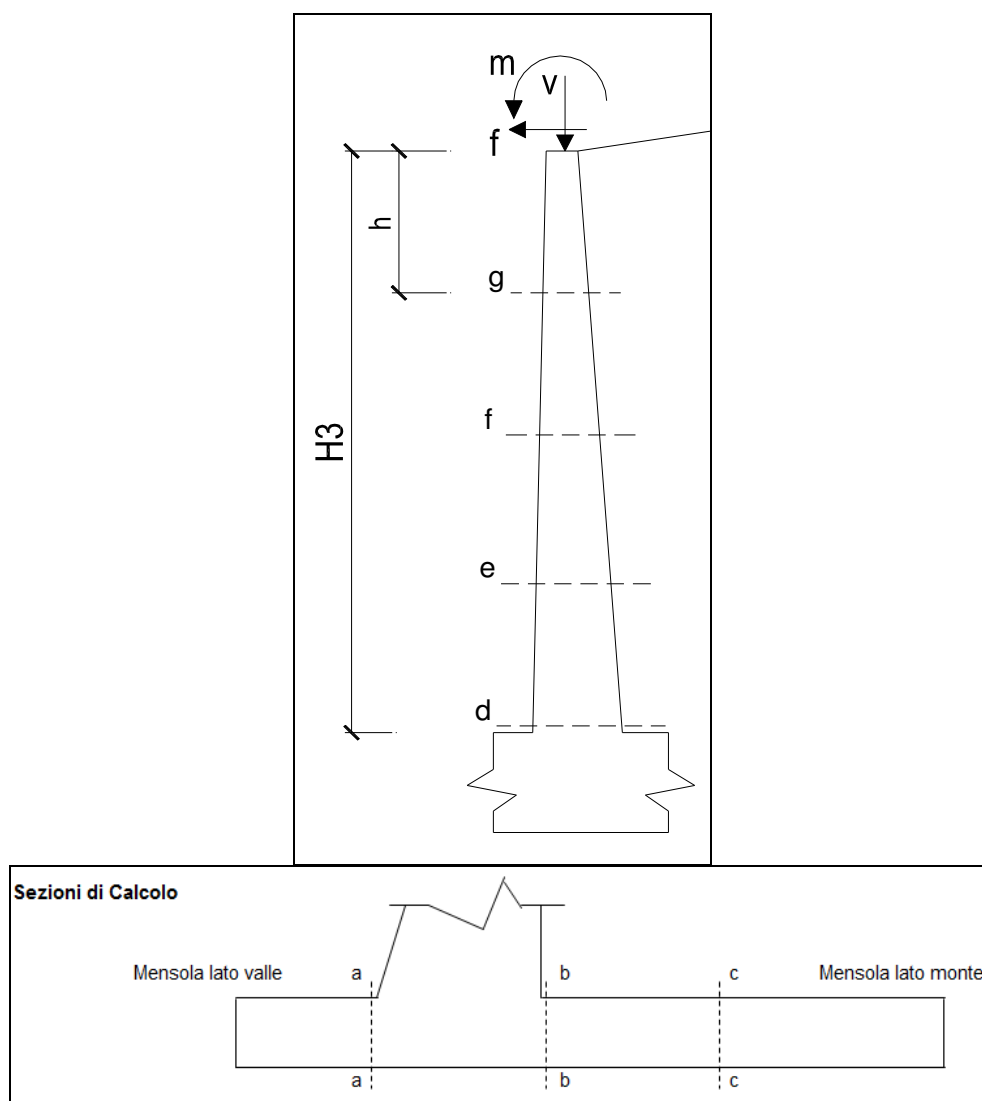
schema grafico con la posizione delle sezioni di calcolo strutturale (paramento e fondazione)
